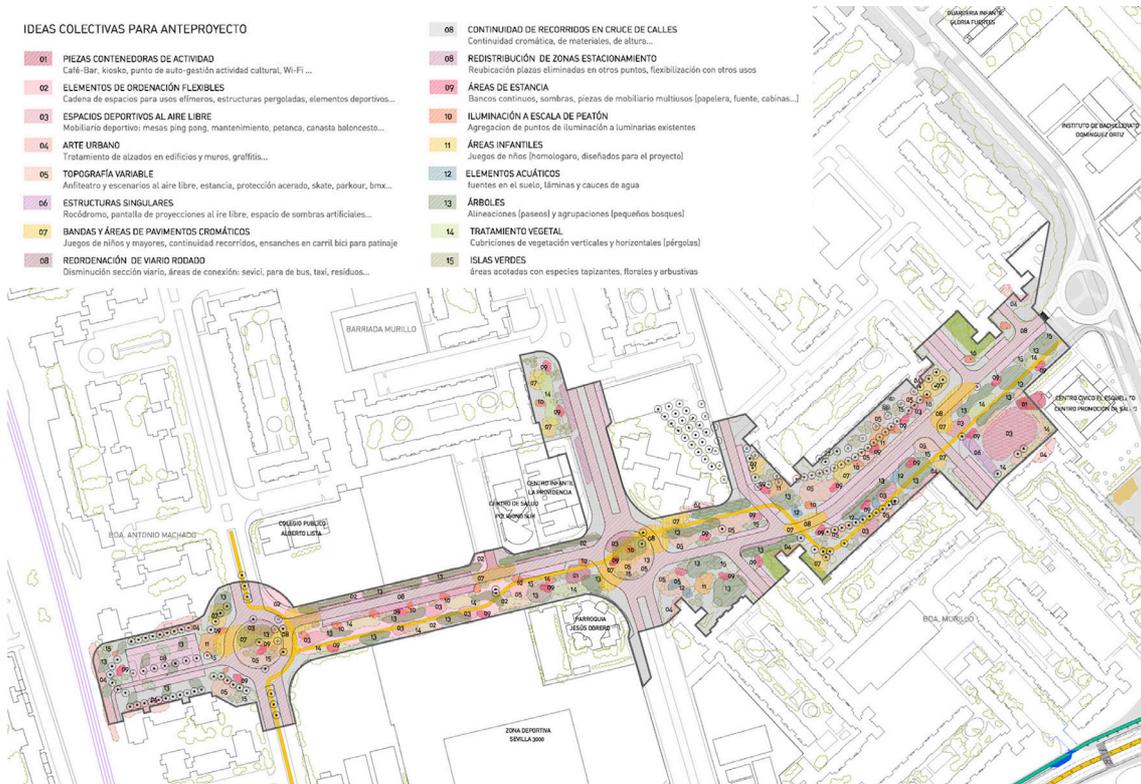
Propuesta de reordenación estructura viaria y ubicación de usos y escenarios. Fuente: Planimetría del autor.
